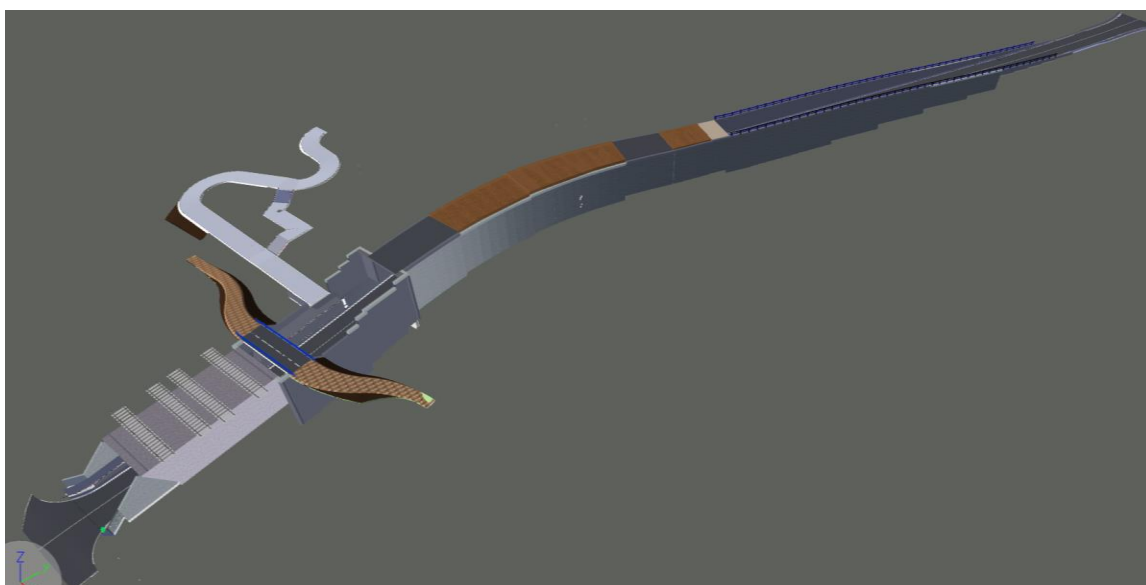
Vista general de la solución desde el sureste. Vista de elementos constructivos.
